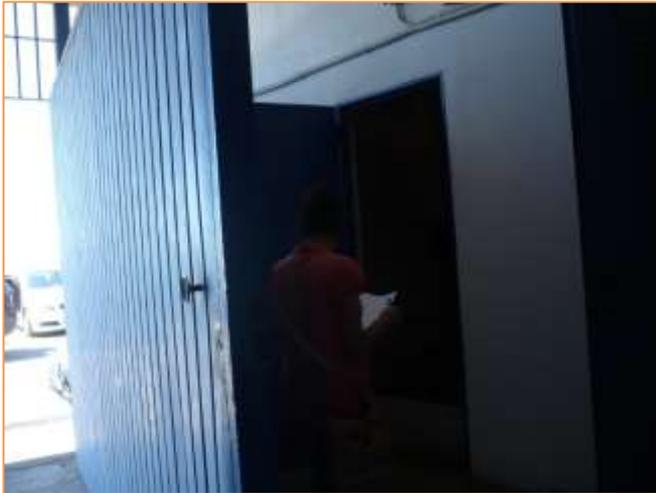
Equipos de producción de calor para ACS. Caldera mural - Edificio secundario – Planta baja
